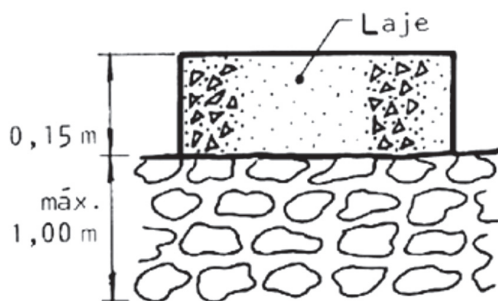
Laje sobre embasamento de pedra de mão (fundação)
